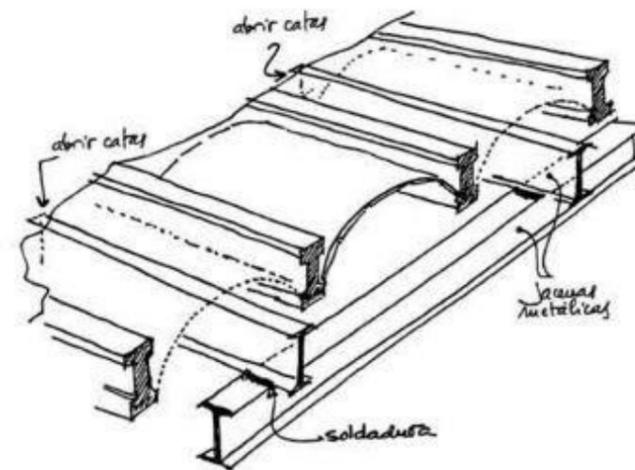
Forjado vigueta metalica bovedilla de ladrillos a revolcón
